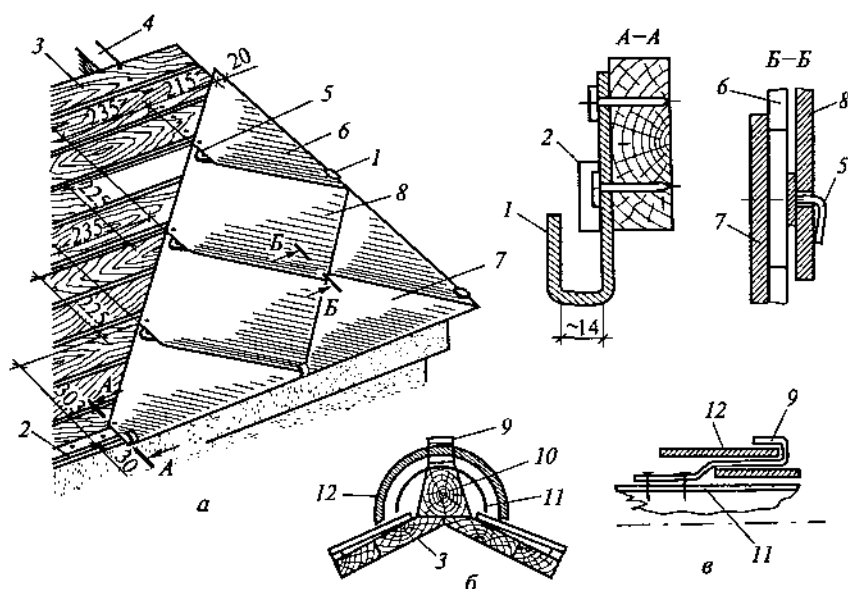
Кровля из асбоцементных плоских плиток:
